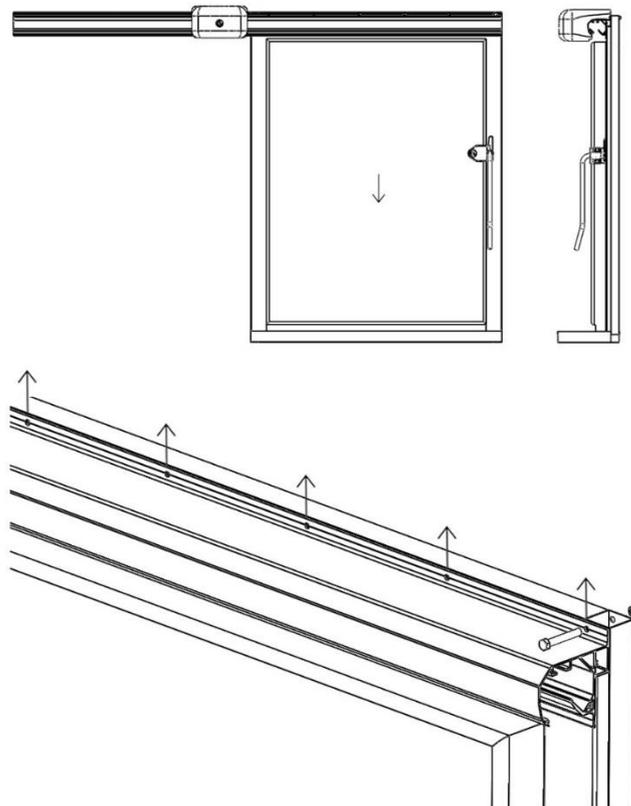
Detalle módulo puerta corredera. Vista alzado y perfil.
